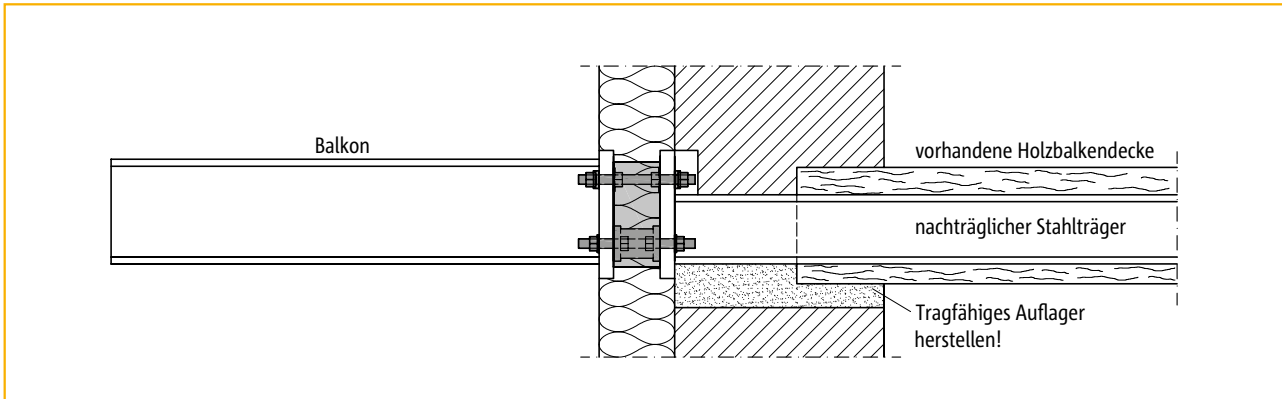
Balkon frei auskragend, angeschlossen mit Typ KST an Holzbalkendecke (Stahlbalken)
